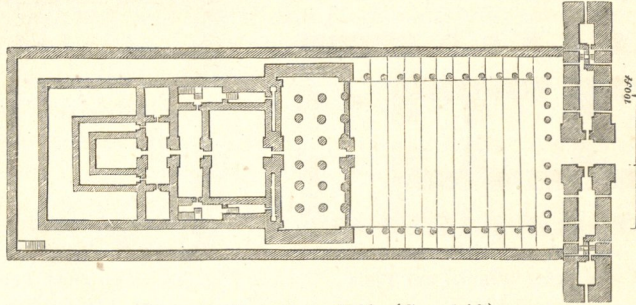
Tempel zu Edfu (Grundriss).
